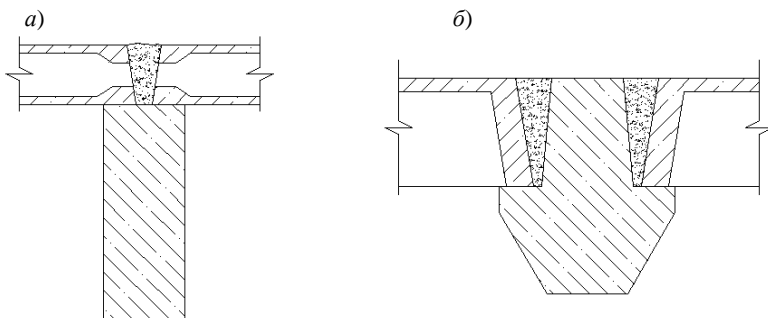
Опираие плит перекрытий на ригель:
